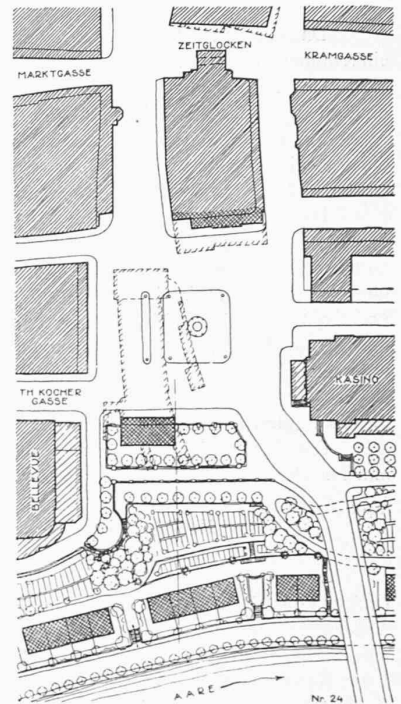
Lageplan 1 : 2500 zu Nr. 24.
